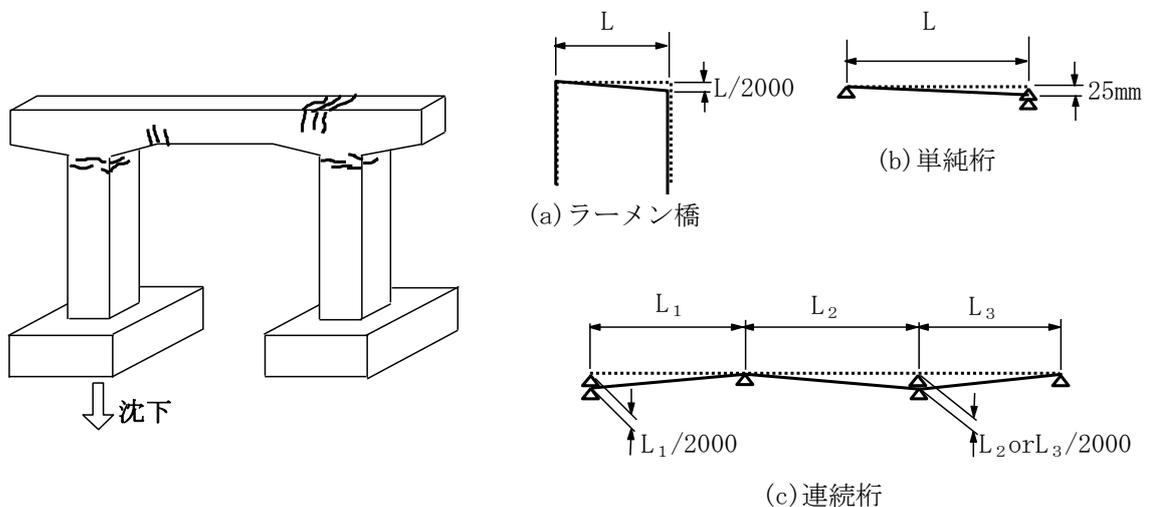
基礎の沈下によるひび割れ例と判定区分の目安
